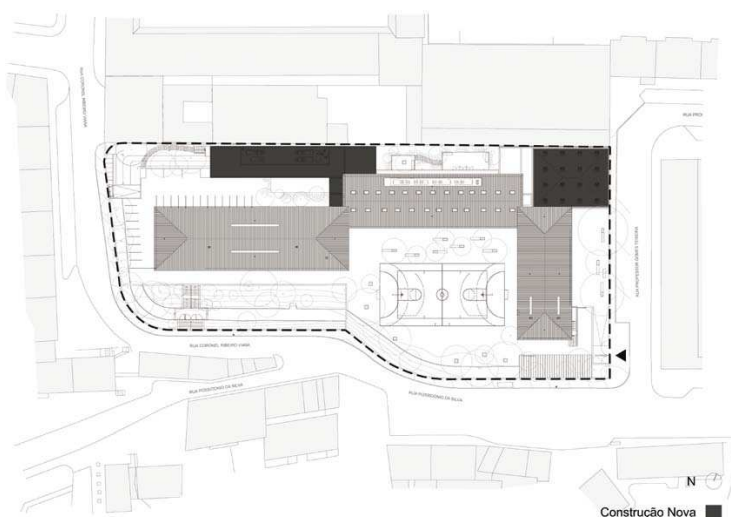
Planta da Construção nova- após intervenção da Parque Escolar.
